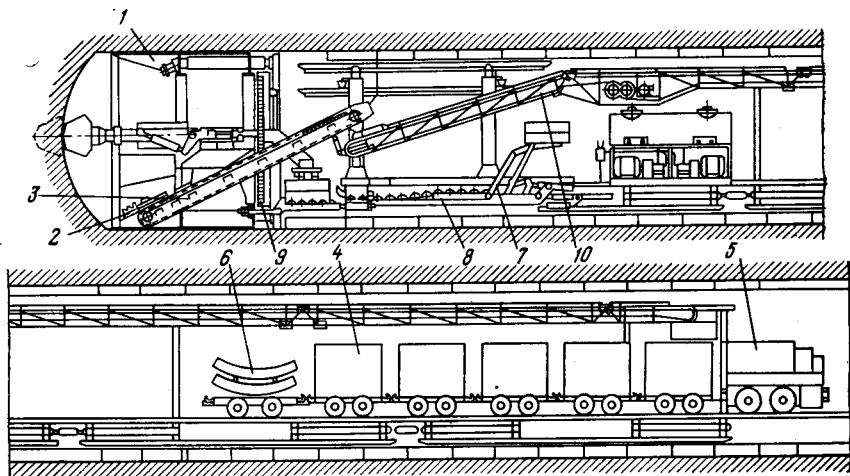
Проходческий механизированный щитовой комплекс:
